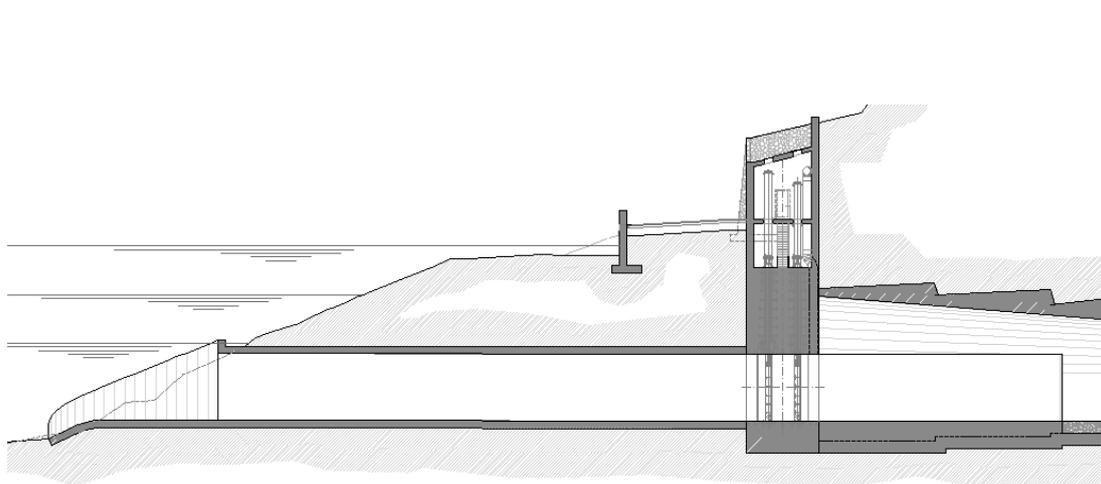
soluzione di imbocco sotto battente prevista nel progetto preliminare
